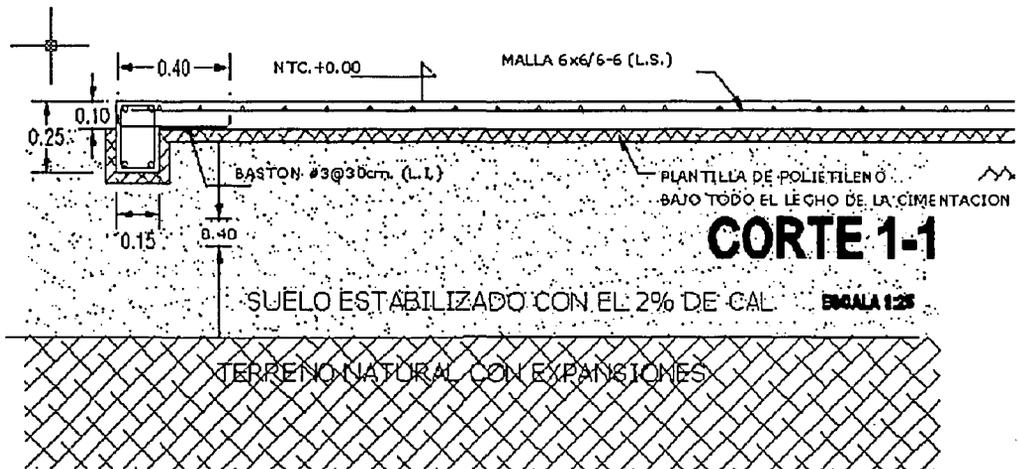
Corte suelo estabilizado con cal, cimentación y terreno natural.
